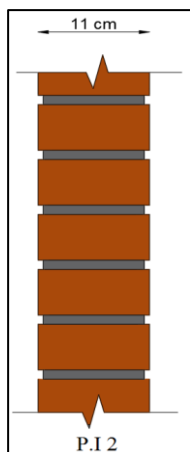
Corte da Parede Interior 2 (P.I 2)
